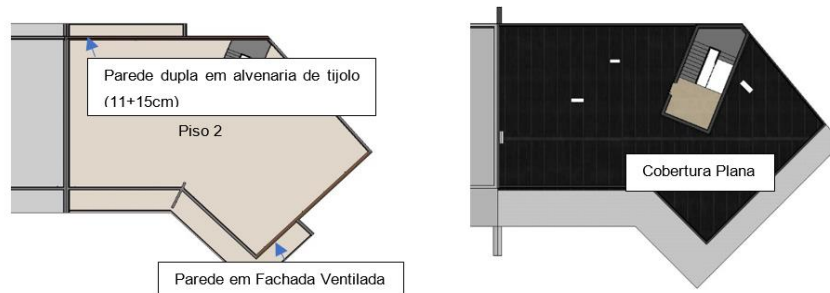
Planta de piso, com a identificação das fachadas, e cobertura.
